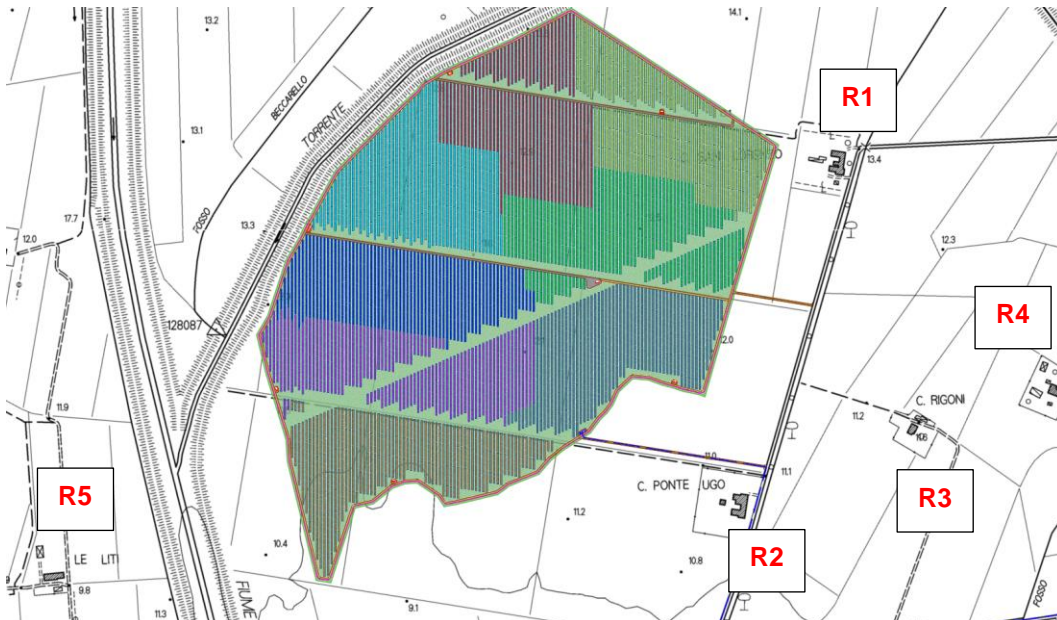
Ricettori entro 100m dalle aree di impianto (R1)
